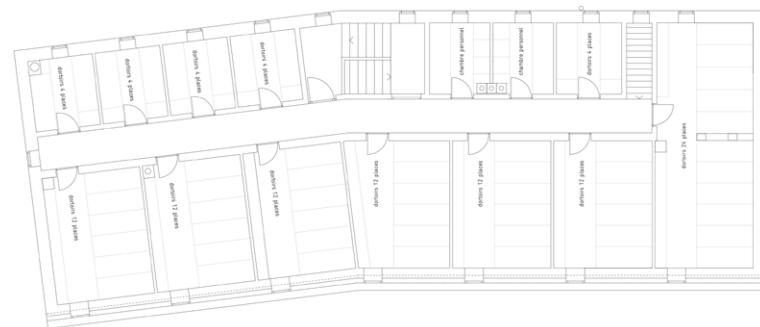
Pianta piano secondo seminterrato del Tracuit Hütte
